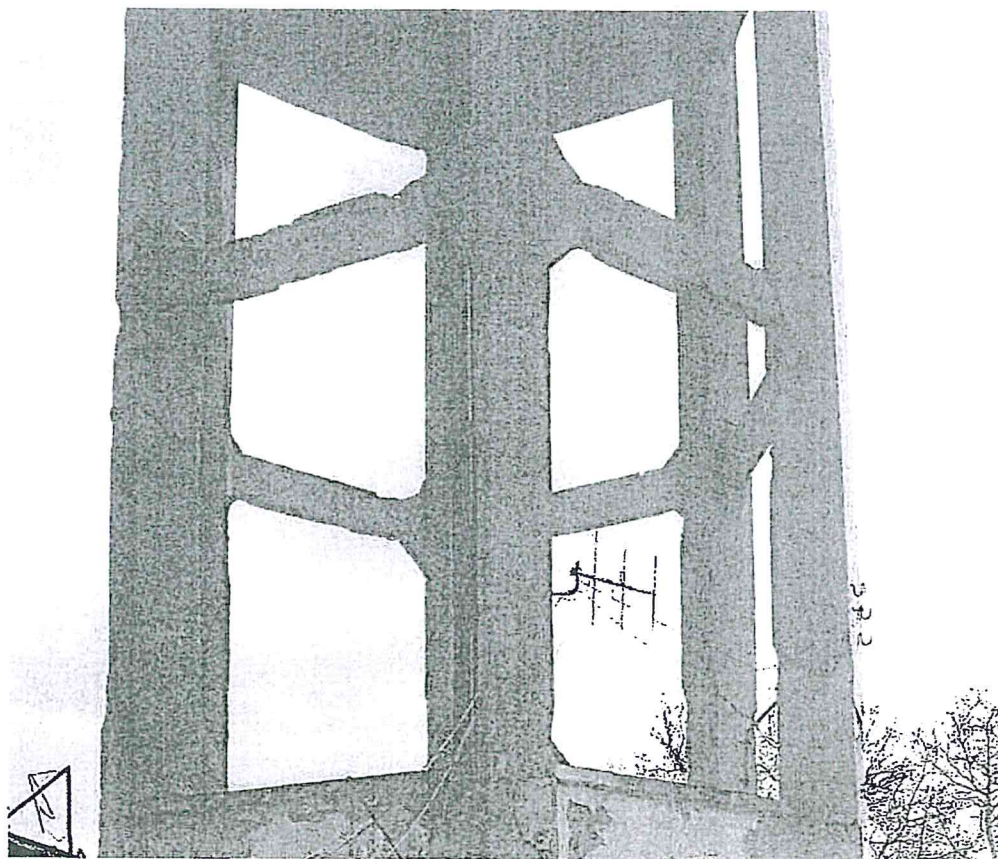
Finisaje dislocate și armături longitudinale aparente în structura stâlpilor
